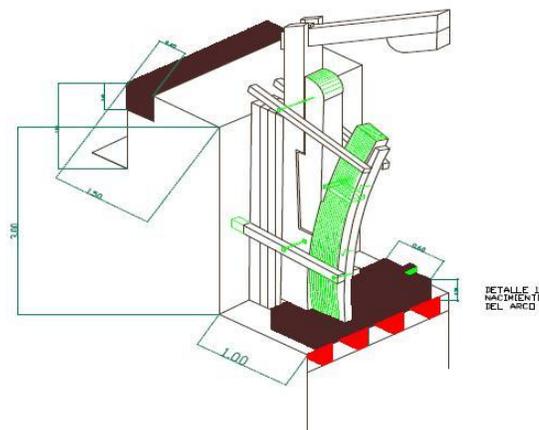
Disposición de la estructura de madera mostrando aisladores del tipo elástico. Francisco Méndez Flores.
